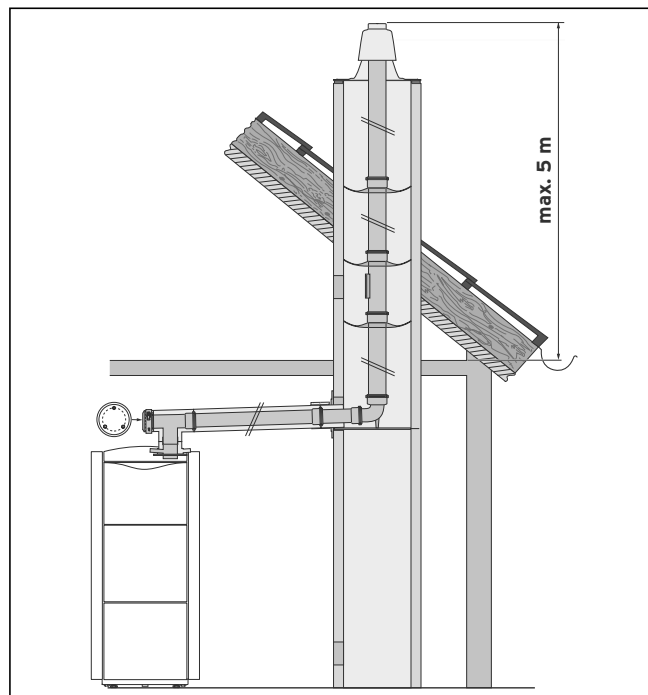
Пример монтажа с забором воздуха не из помещения
